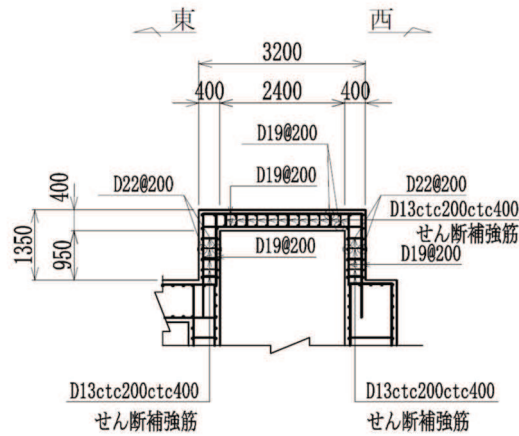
復水貯蔵タンク基礎 概略配筋図 (5-5 断面)
